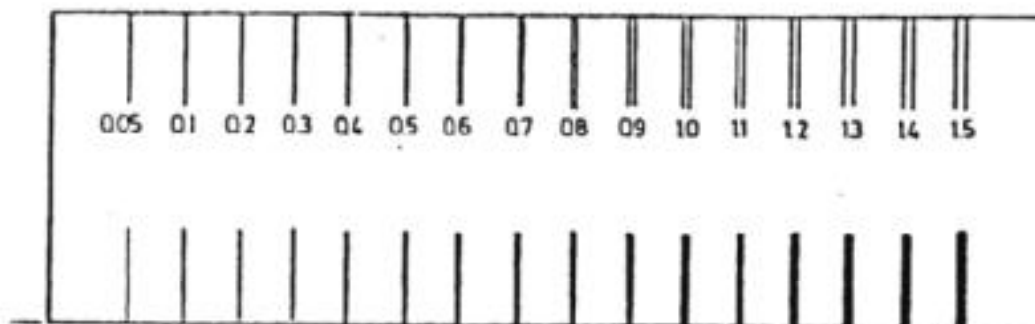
Grietómetro para medir anchos de grietas (ref. 11)
